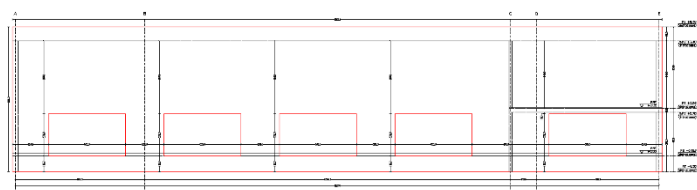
Prospetto sud-ovest setti palestra: strutture in progetto
